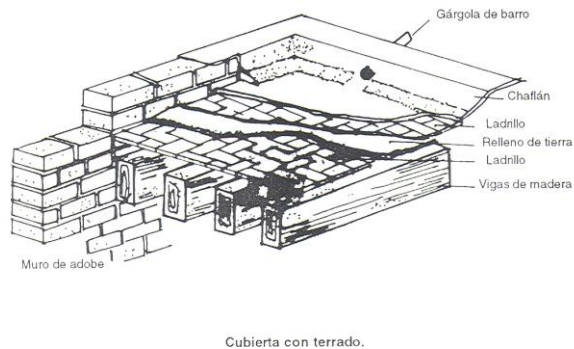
figura de un corte tipo de techumbre plana en la cual las vigas pueden ser de sección rectangular o redonda (morillos)
